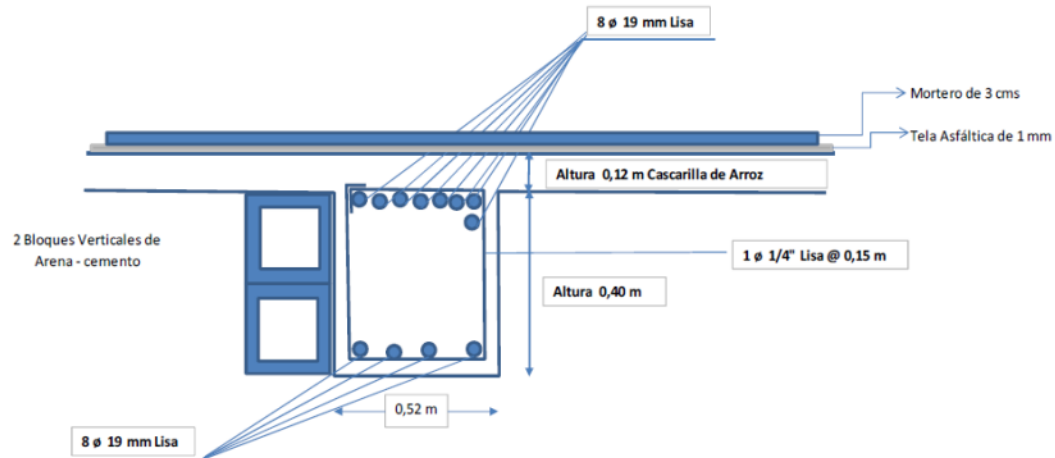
Viga C entre Ejes 6-7 Tercer Piso Segunda Placa
